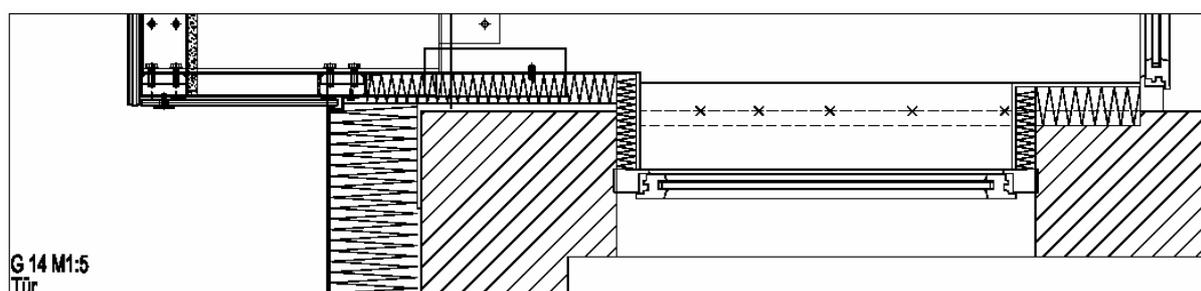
Detail G 14 Horizontalschnitt Balkonanschlusswand inkl. Balkontür
